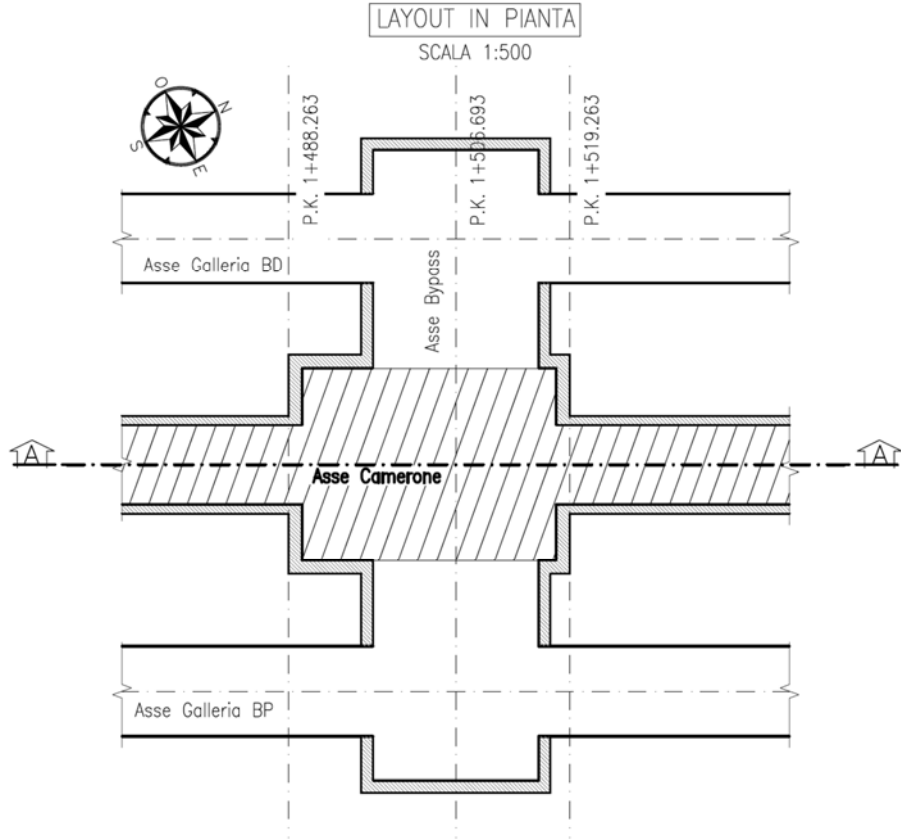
Camerone smontaggio TBM, fase 1, profilo longitudinale, planimetria, layout in pianta.
